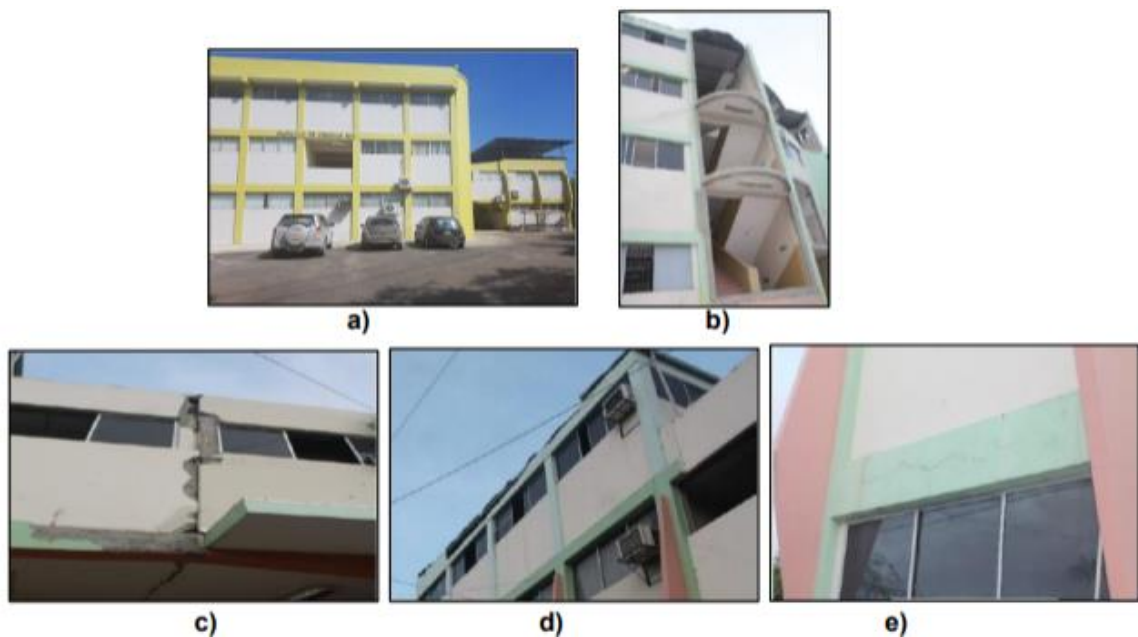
a) Fachada posterior de la Facultad de Comercio Exterior de la ULEAM b) Daños en las paredes del descanso de la escalera y daño en el la cubierta; c) Daño en la junta de construcción entre la facultad de Comercio Exterior y Economía por efecto del movimiento del bloque durante el sismo. d) Agrietamiento en vigas (Daño en vigas perimetrales de la cubierta) e) Daño en vigas del segundo piso.
